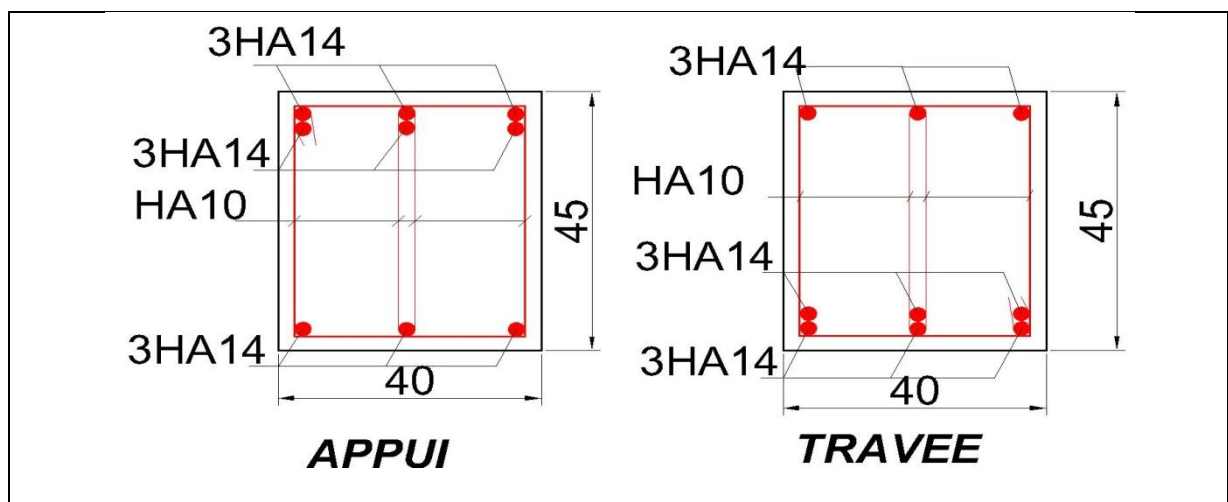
Schémas de ferrailage des poutres principales pour les entres sols
